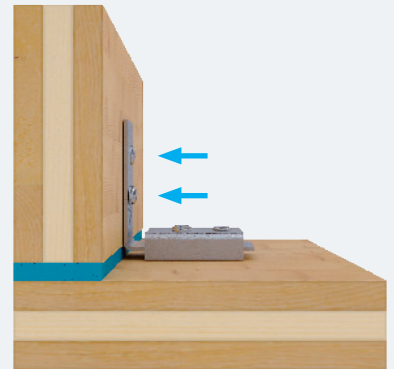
Pasos de instalación de Straviwood WallBracket, que muestra el sistema de precompresión, diseñado para evitar la sobrecompresión.
